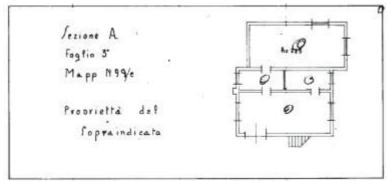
Estratto planimetria catastale, relativa al piano terra
